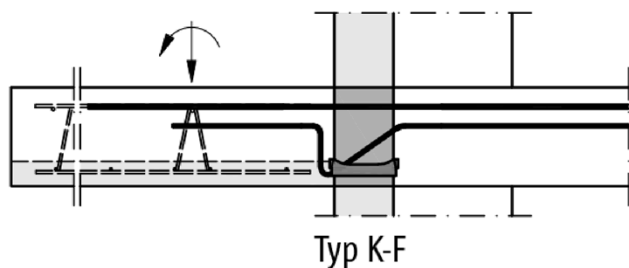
Schöck Isokorb® Typ K-F für frei auskragende Balkone in Elementbauweise (Variante mehrteilig)
